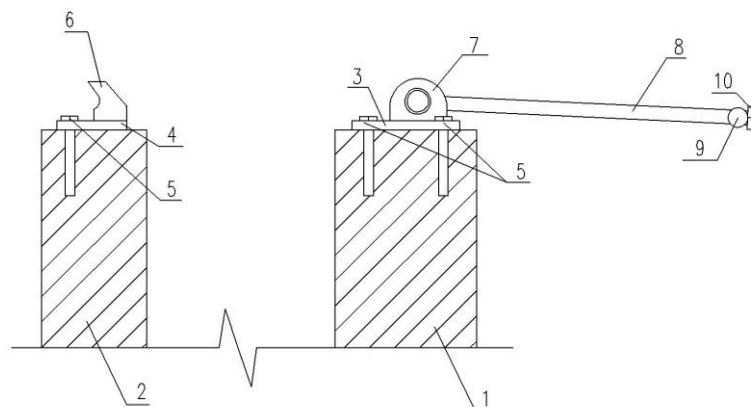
Конструктивное исполнение замка для строительных конструкций в нерабочем состоянии (вид сбоку) 1- стена, раскрепленная поперечными стенами; 2 – раскрепляемая стена; 3; 4 – стальные пластины; 5 – осевые отверстия для крепления; 6 – крюк; 7 – проушина; 8 – стержень; 9 – элемент зацепления; 10 – гайка
